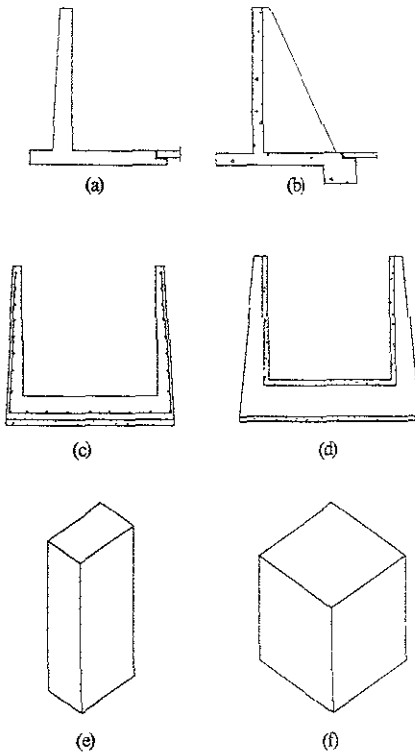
Estructuraciones de tanques rectangulares sobre el terreno
